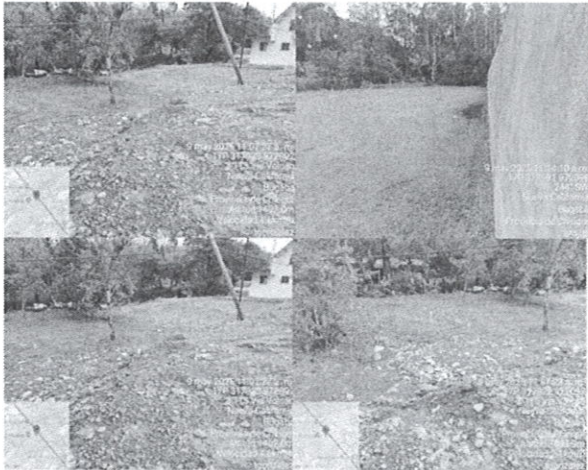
Vista panorámica del terreno, parte del muro construido y el relleno realizado. Fuente: T. González. 2025
